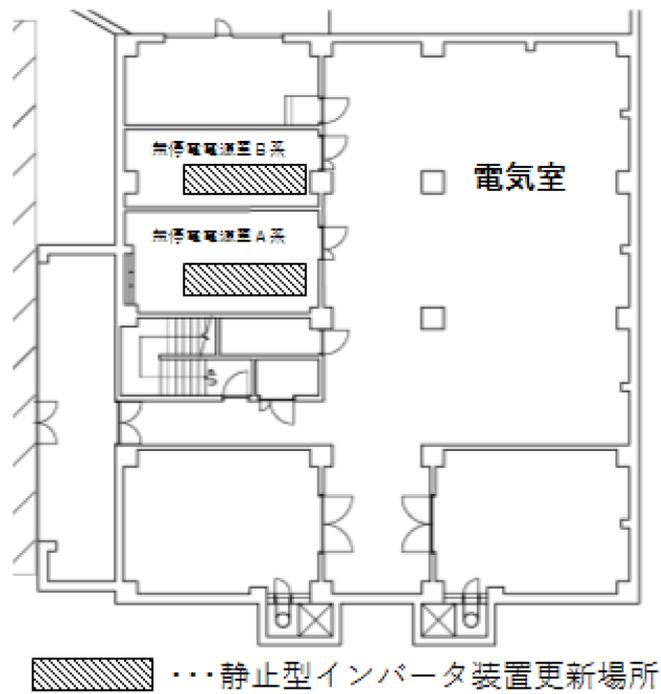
原子炉制御棟地階平面図（静止型インバータ装置）
